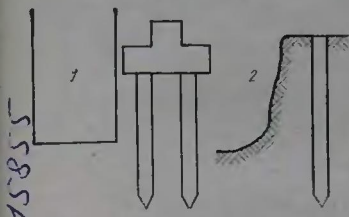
Схема расположения свай вблизи заглубленных помещений 1 или оврагов 2
